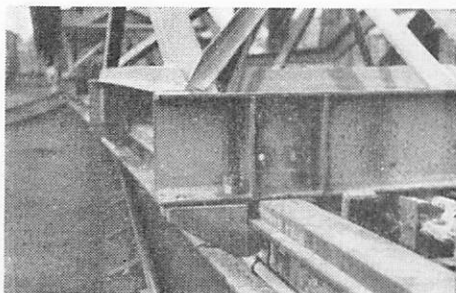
Detalj av bocken och dess fastspänning mot överföringsvagnens långbalk.
